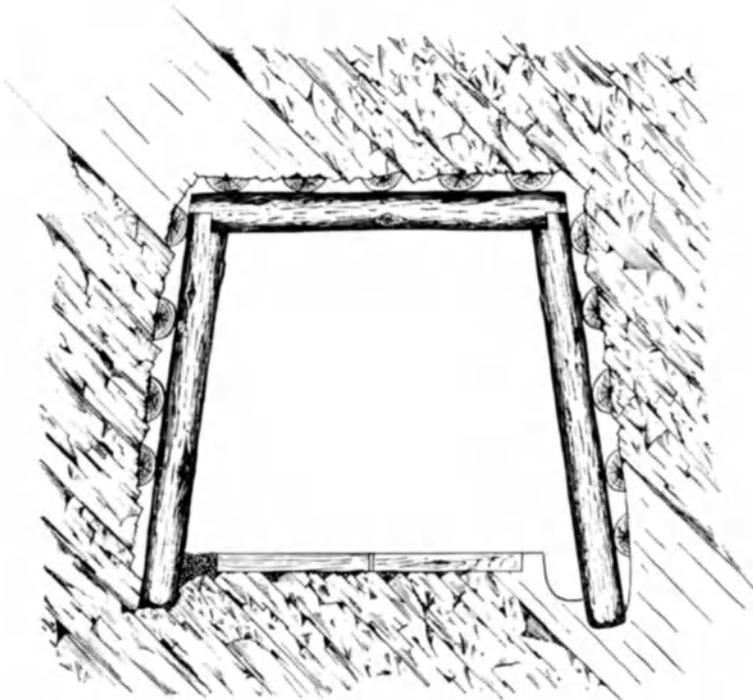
Deutscher Türstock mit schrägen Beinen.
